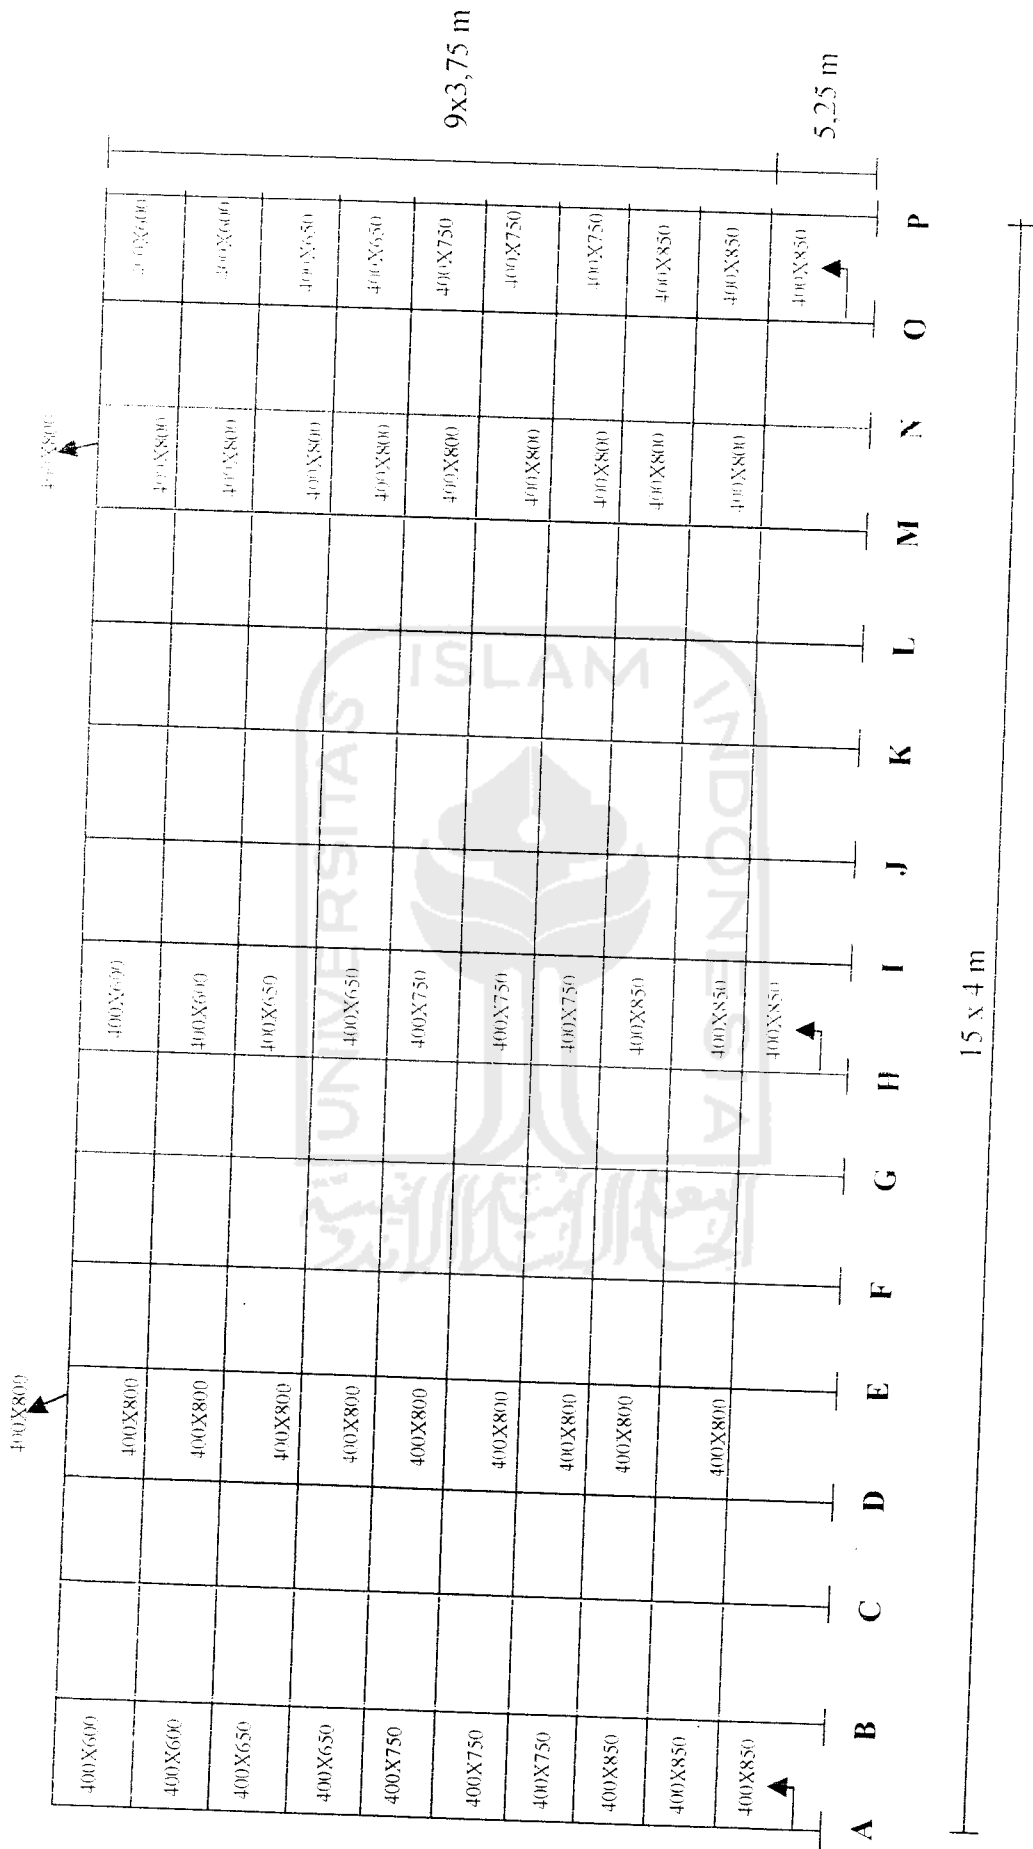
Denah tampak melintang portal dengan *shear wall
